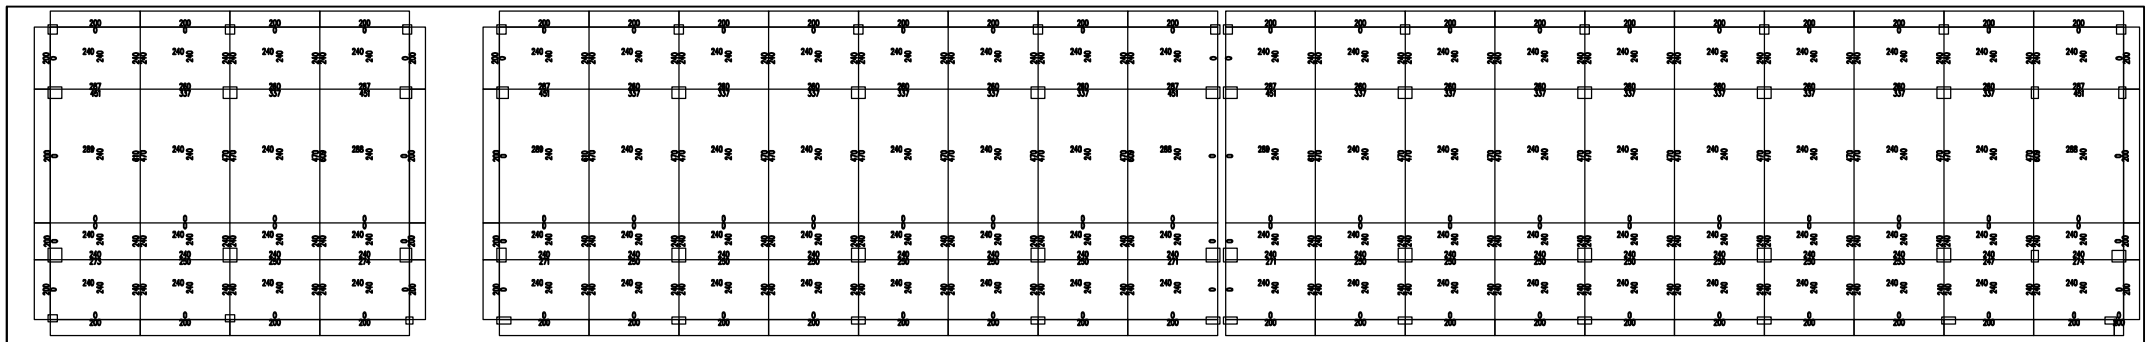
某工程(1) 楼上的板配筋平面图(单位:cm)
